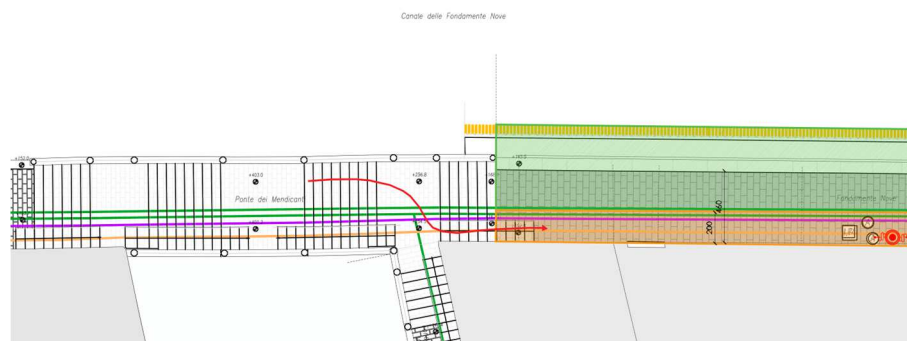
ORGANIZZAZIONE CANTIERE – FASE 1 (SU SINGOLO LOTTO)
